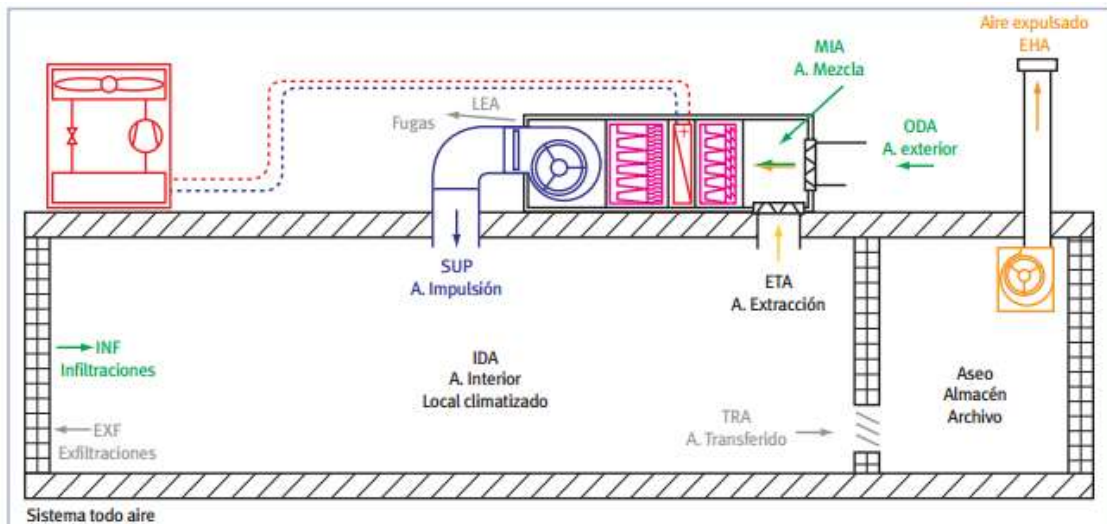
ESQUEMA DE CLIMATIZACIÓN PARA LA ZONA DE HOSTELERÍA Y BAÑOS PLANTA BAJA
